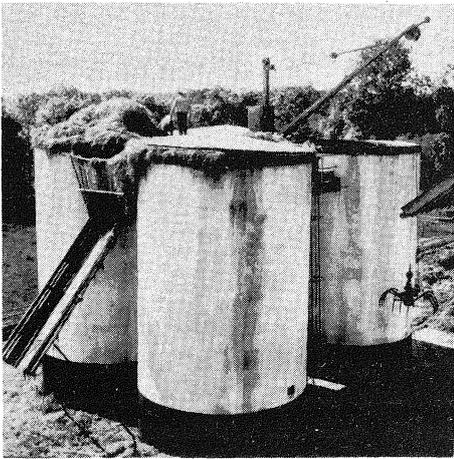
Hochsiloanlage: $4 \times 200 \text{ m}^3$. Drehkrananlage für Befüllung und Entleerung. Beton-Formsteine. Innen- und Außenanstrich ist mindestens alle zwei bis drei Jahre erforderlich, um die Haltbarkeit des Behälters zu erzielen.
